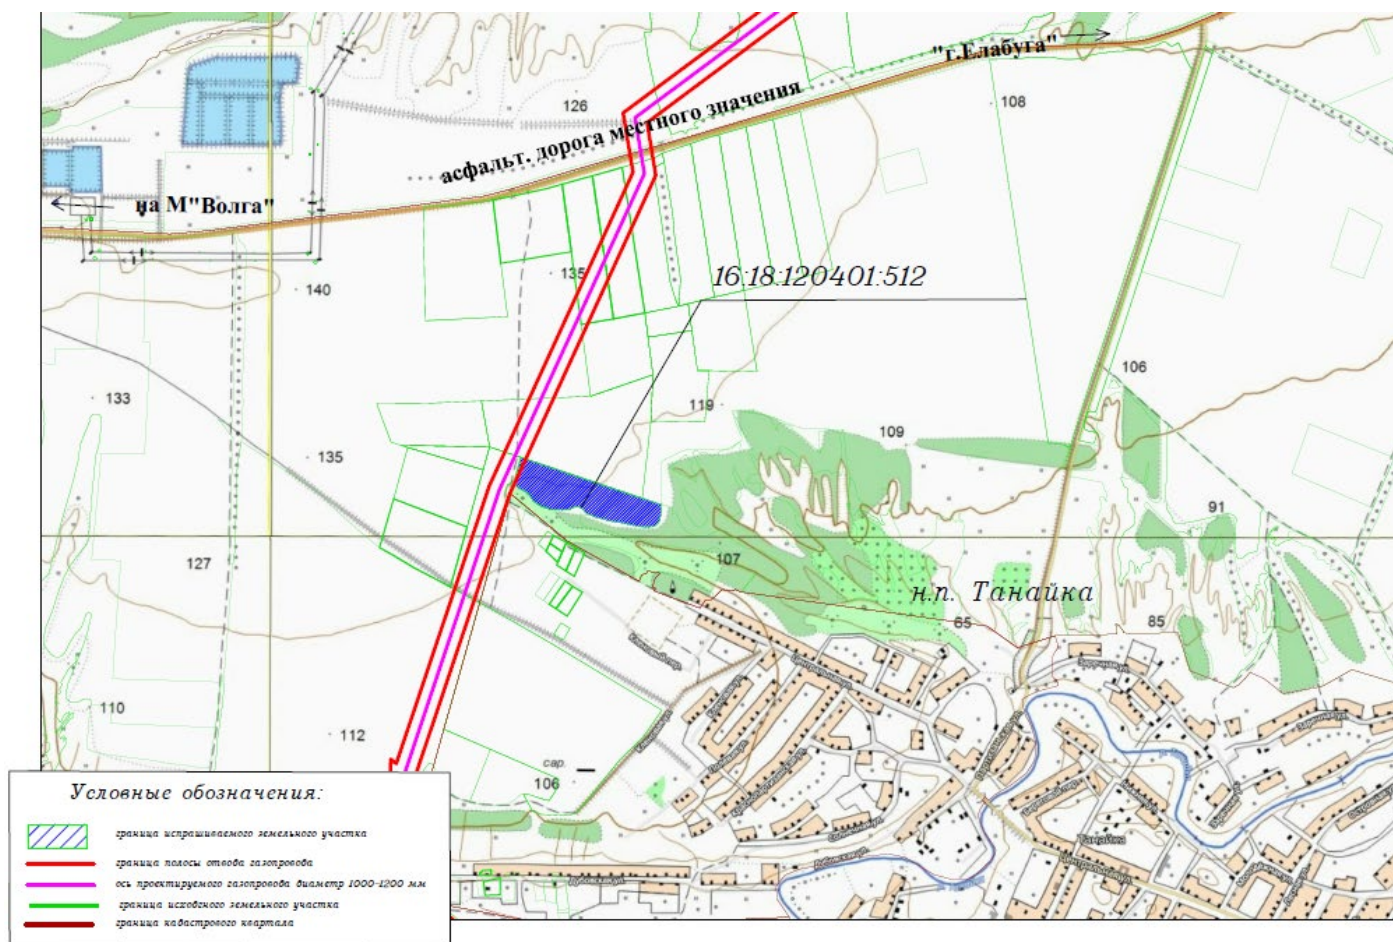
Схема размещения проектируемого газопровода на кадастровом плане территории для предварительного согласования
